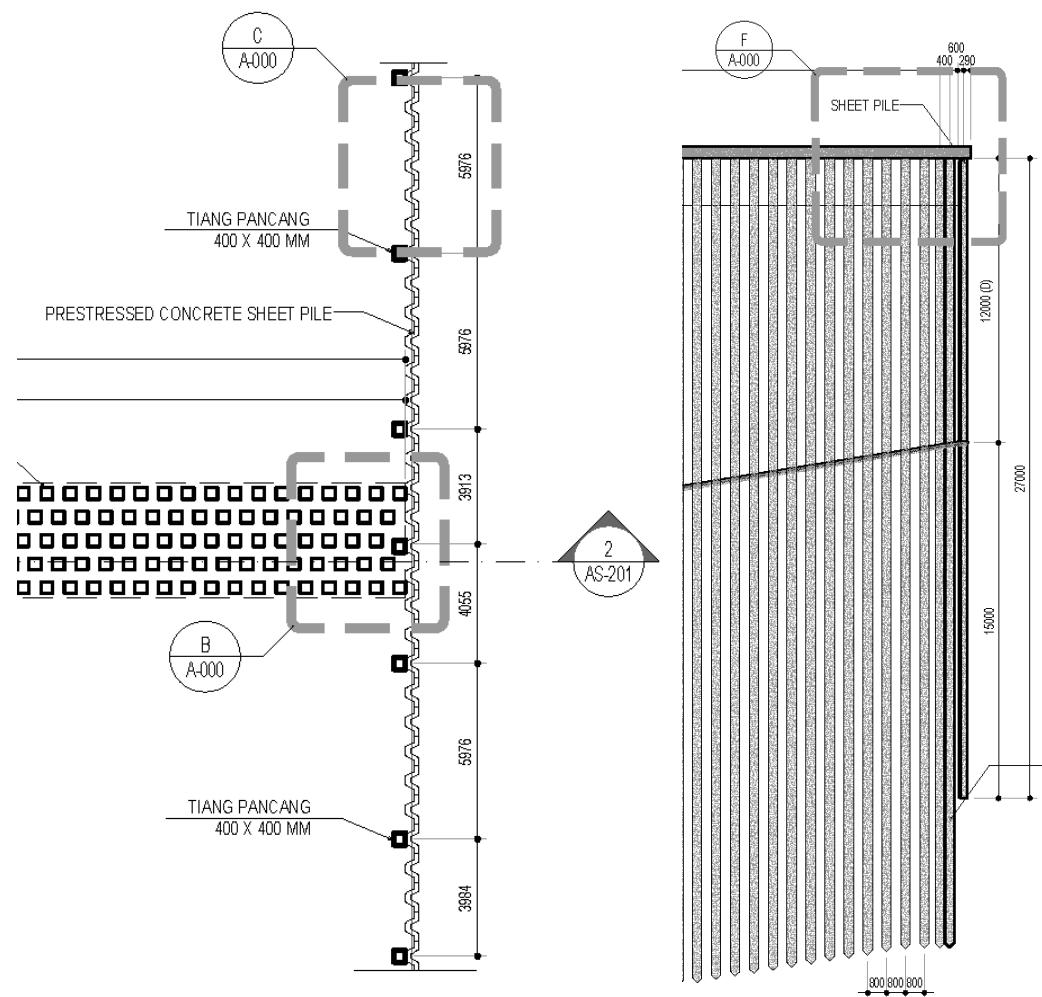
Detail G dan Profil Alternatif 1 *Sheetpile
